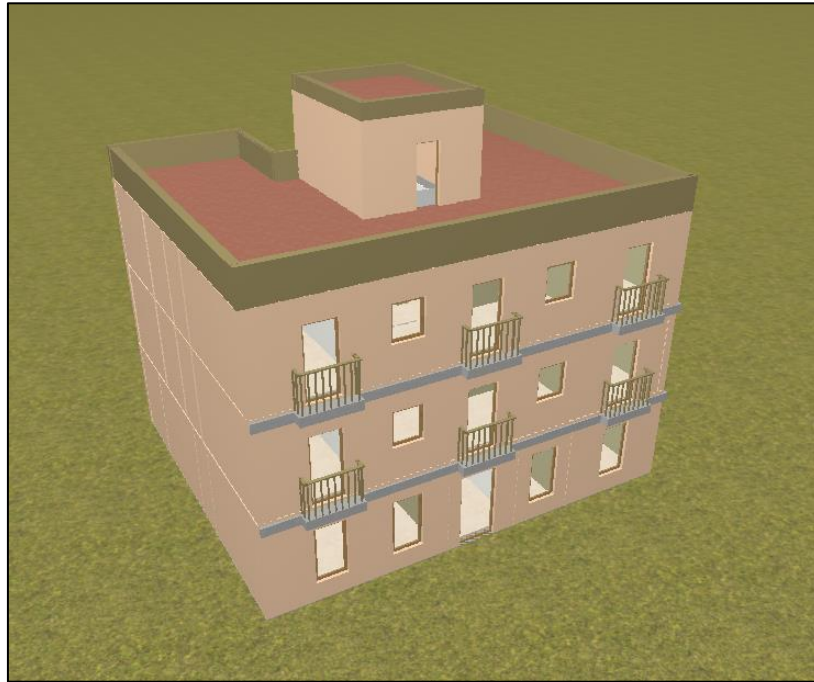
Modelo 3D del edificio. Vista de la fachada delantera.
